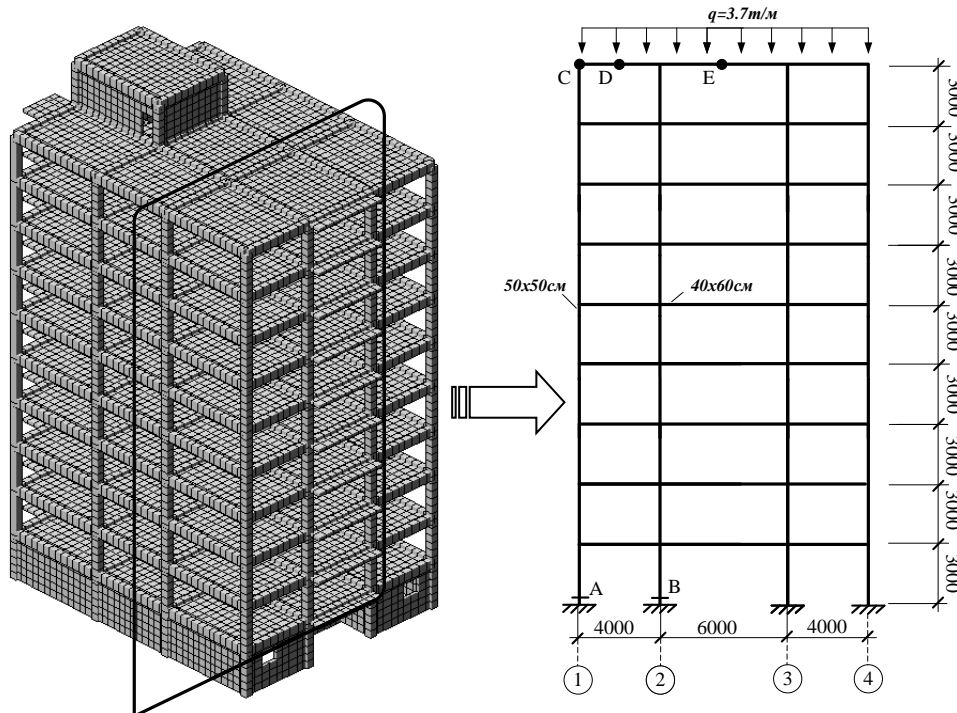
Расчетная схема 9-ти этажного монолитного здания
